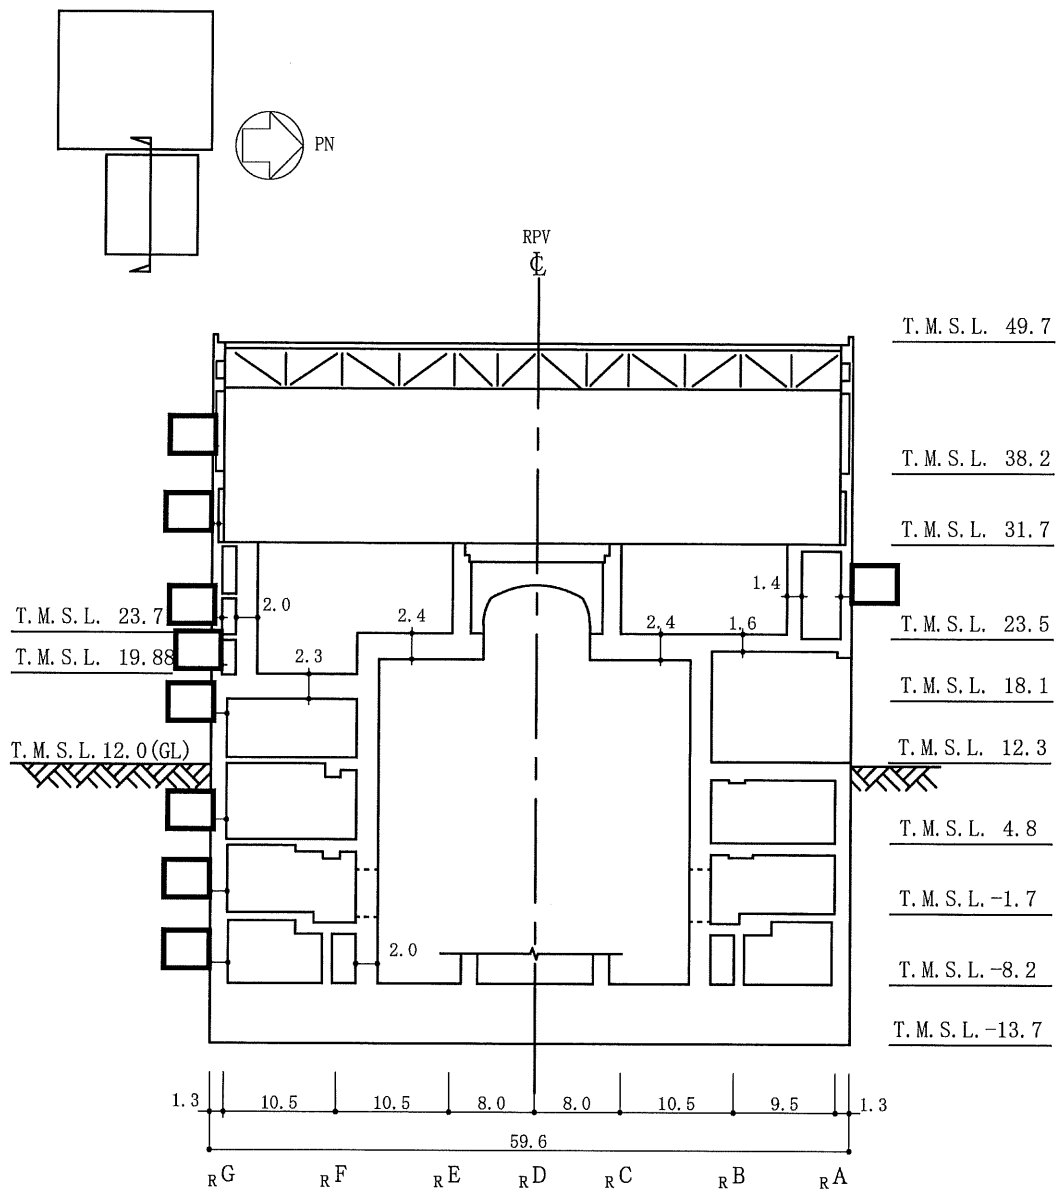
原子炉建屋の概略断面図 (EW方向) (2/2) (単位 : m)
